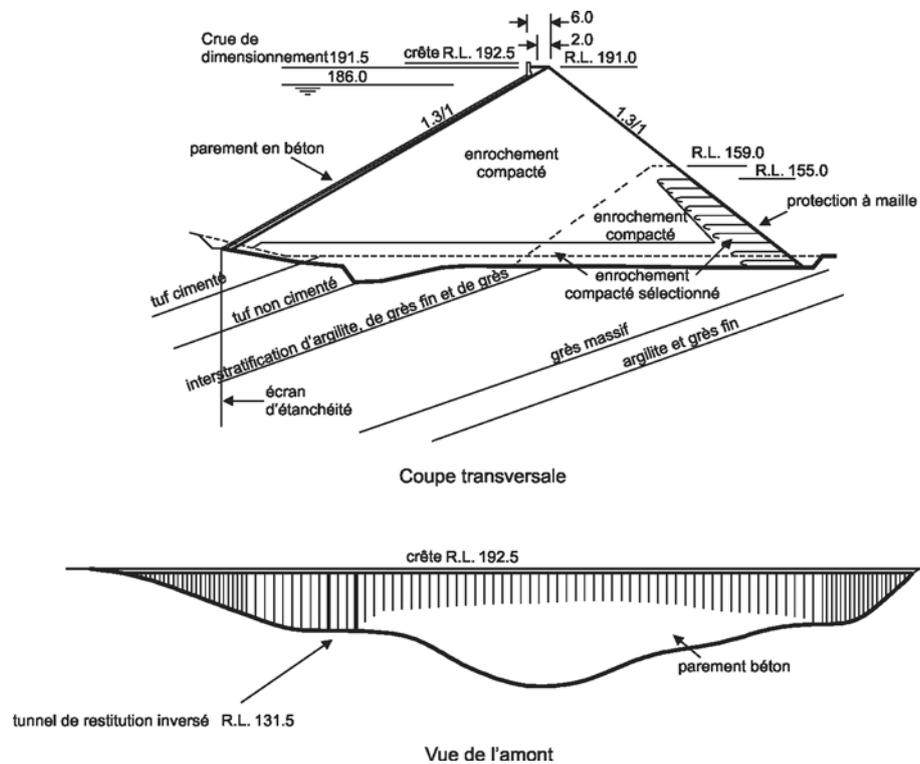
Treillis de protection de l'enrochement d'un batardeau, par la suite intégré dans le barrage principal (R.L. : niveau de référence local, dimension en m)
